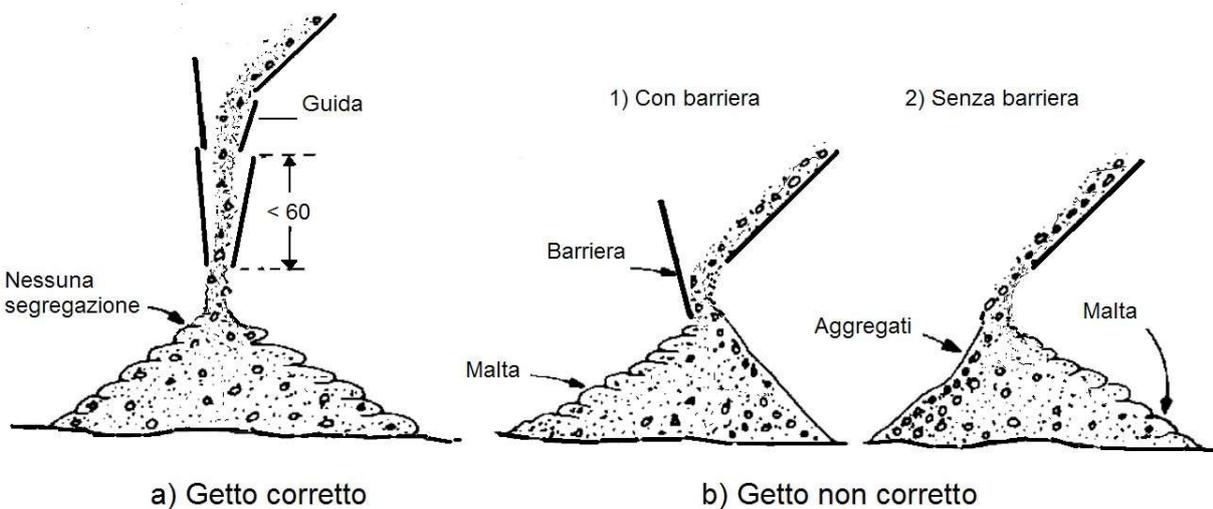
Esempi di getto di calcestruzzo da piano inclinato: a) getto corretto e b) getto non corretto. Nel caso b) si ha la separazione degli aggregati dalla malta cementizia. La barriera comporta soltanto il cambiamento di direzione della segregazione.
